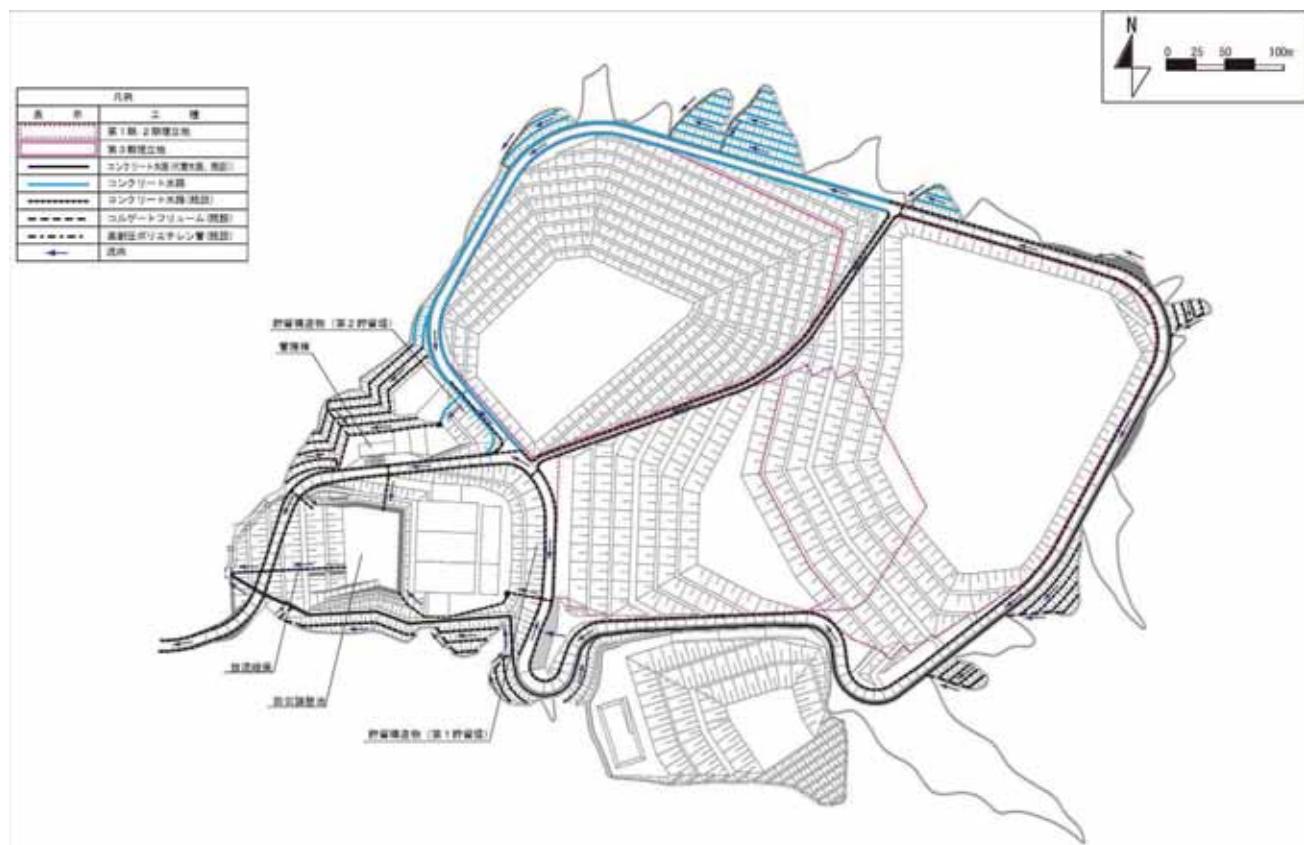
雨水集排水施設配置図 埋立地周辺（第3期整備）
